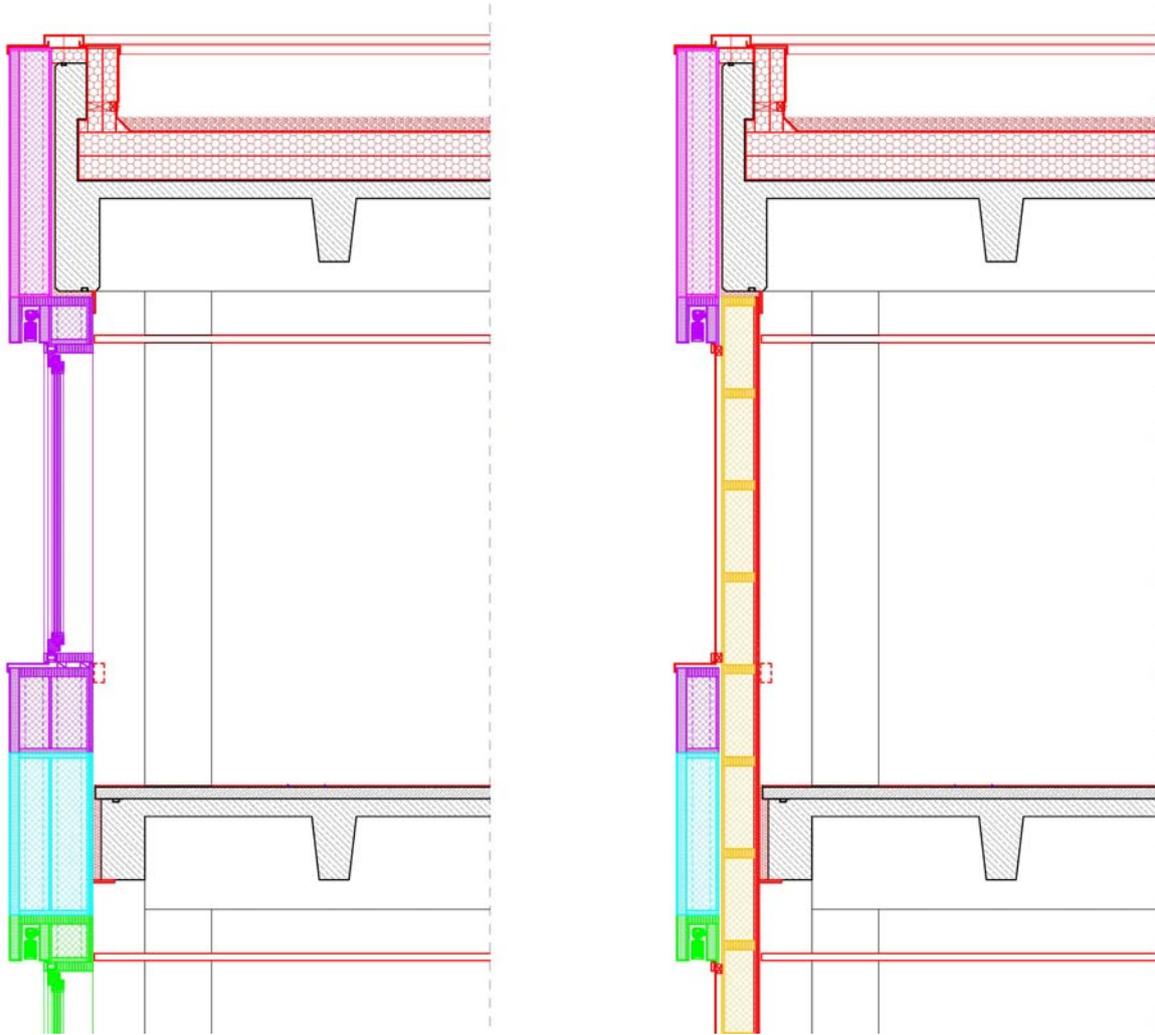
Fassadenschnitt Ostfassade 2.OG ohne und mit Fensterpaneel
